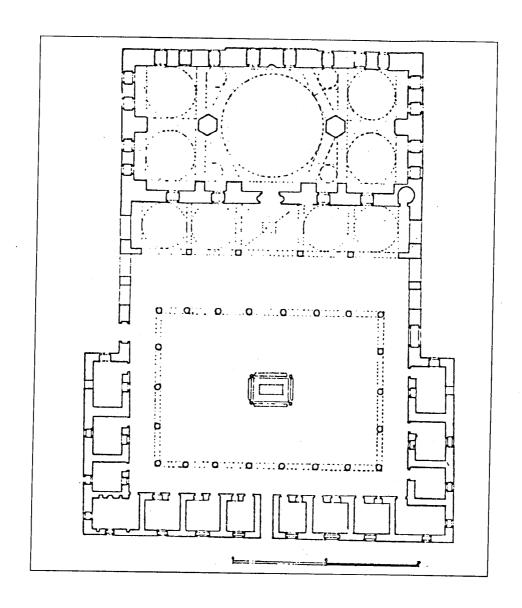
مسقط أفقي لمسجد قيرشنلو محمد باشا في شقودر بألبانيا (عن : كيل) .
